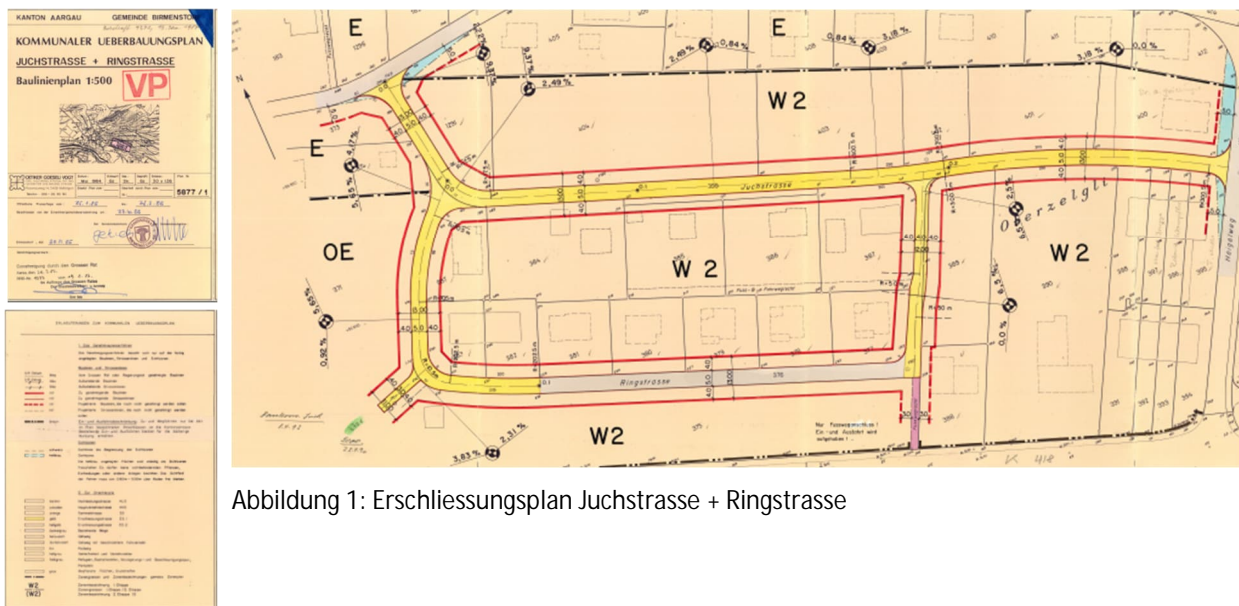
Erschliessungsplan Juchstrasse + Ringstrasse
